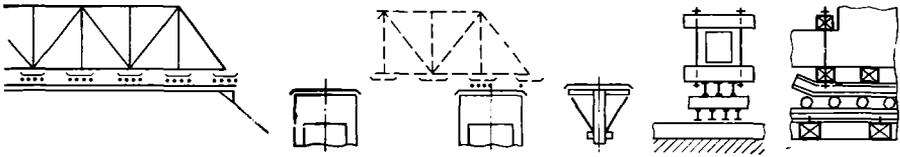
Расположение пролетного строения для продольной передвижки на катках и деталь накаточных путей
